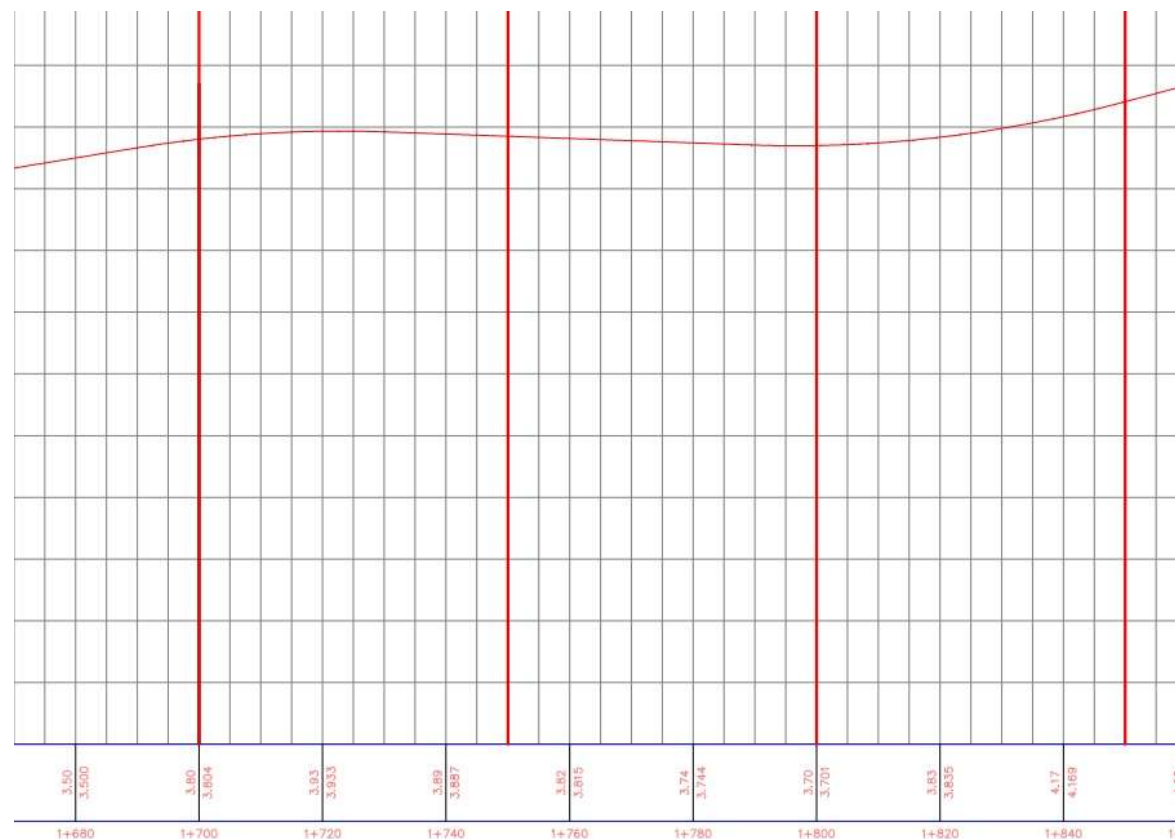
Forma de la rasante entre PK 1+700 y PK 1+800. Fuente: planos de la oficina técnica
